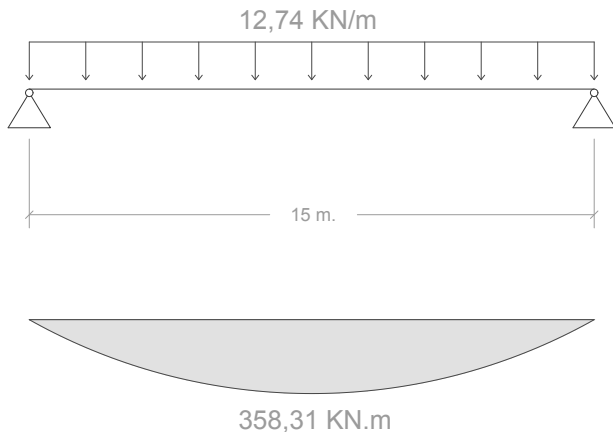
Esquema del cálculo. Forjado 4 - Cubierta.
